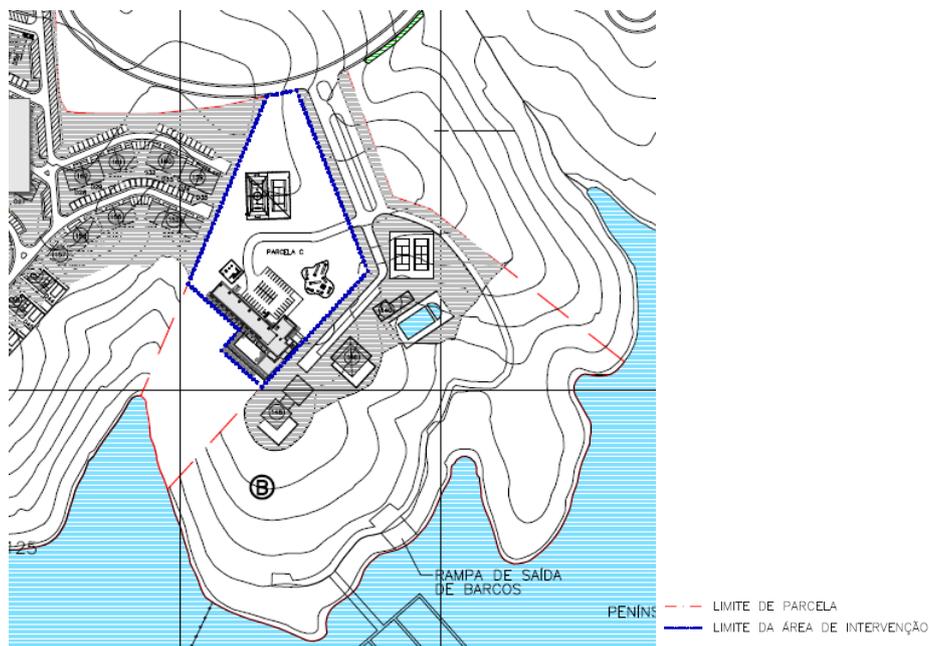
Extrato da Planta de Implantação com o limite da área de intervenção, 2021
